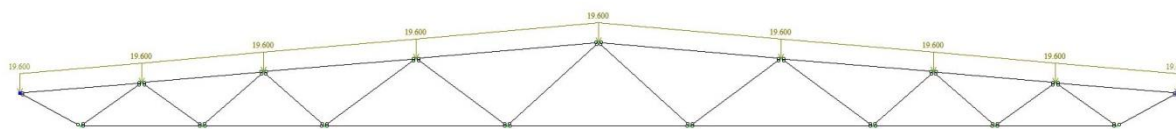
Расчетная схема фермы со снеговой нагрузкой
